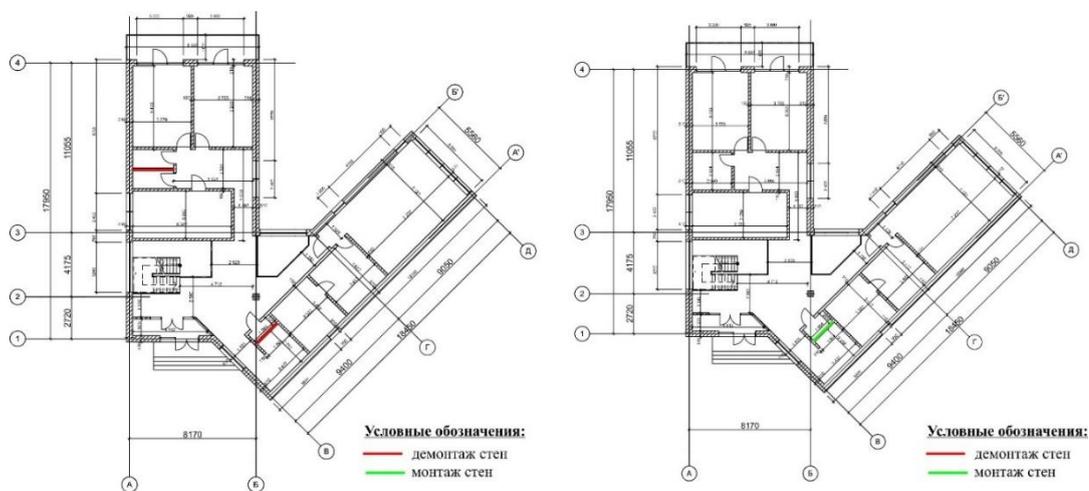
План демонтажа и монтажа 1-го этажа на отметке 0.000
